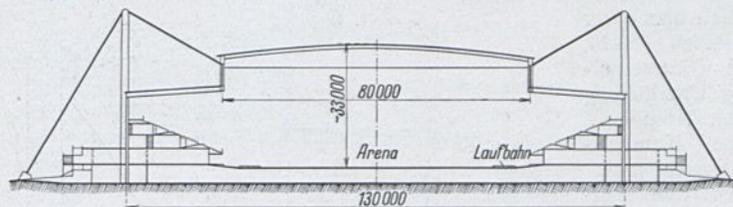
Entwurf Gutschow. Ursprünglich geplante Hängekonstruktion.
